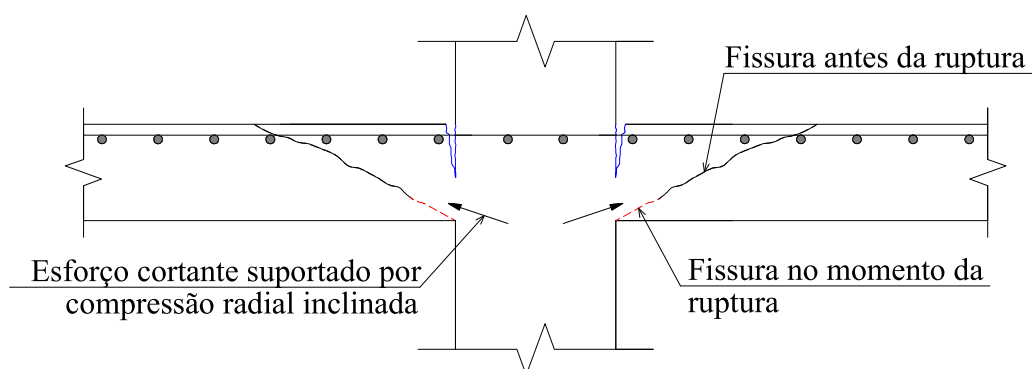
Representação esquemática da ruptura por punção para lajes lisas de concreto armado sem armadura de cisalhamento (CEB-FIP/MC90:1993)
